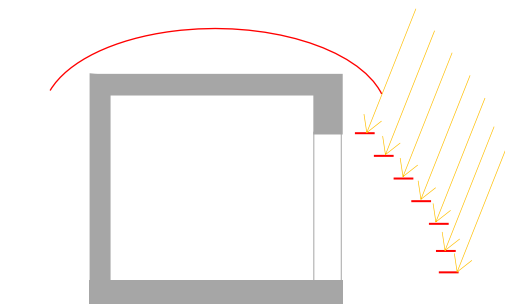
Elementos horizontales de protección solar. Fuente: Elaboración propia.
